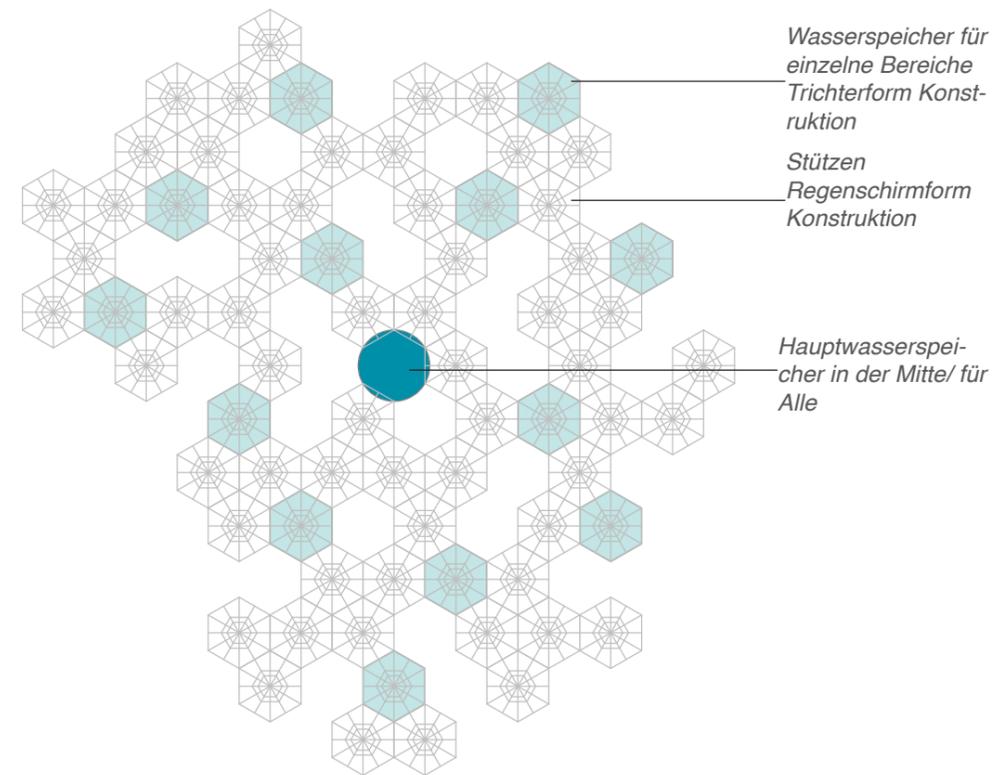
Schema Wasserspeicherung mit Konstruktion
